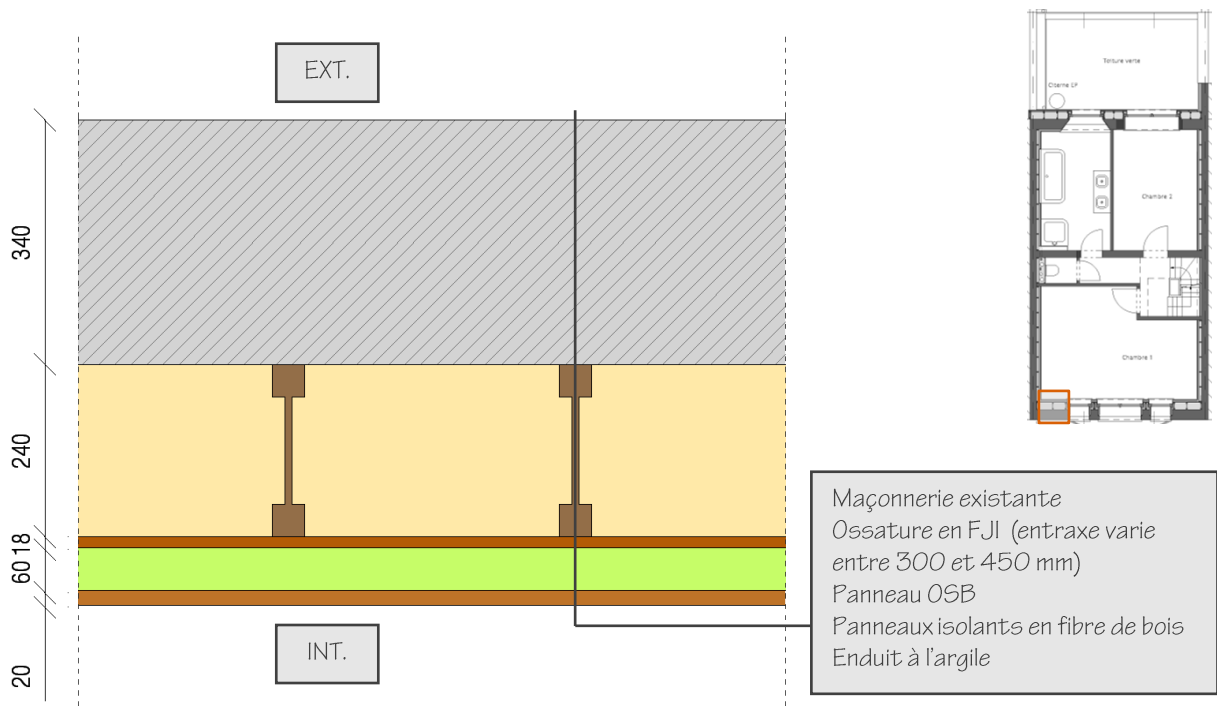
Détail en plan de la façade avant, mesures en [mm]
